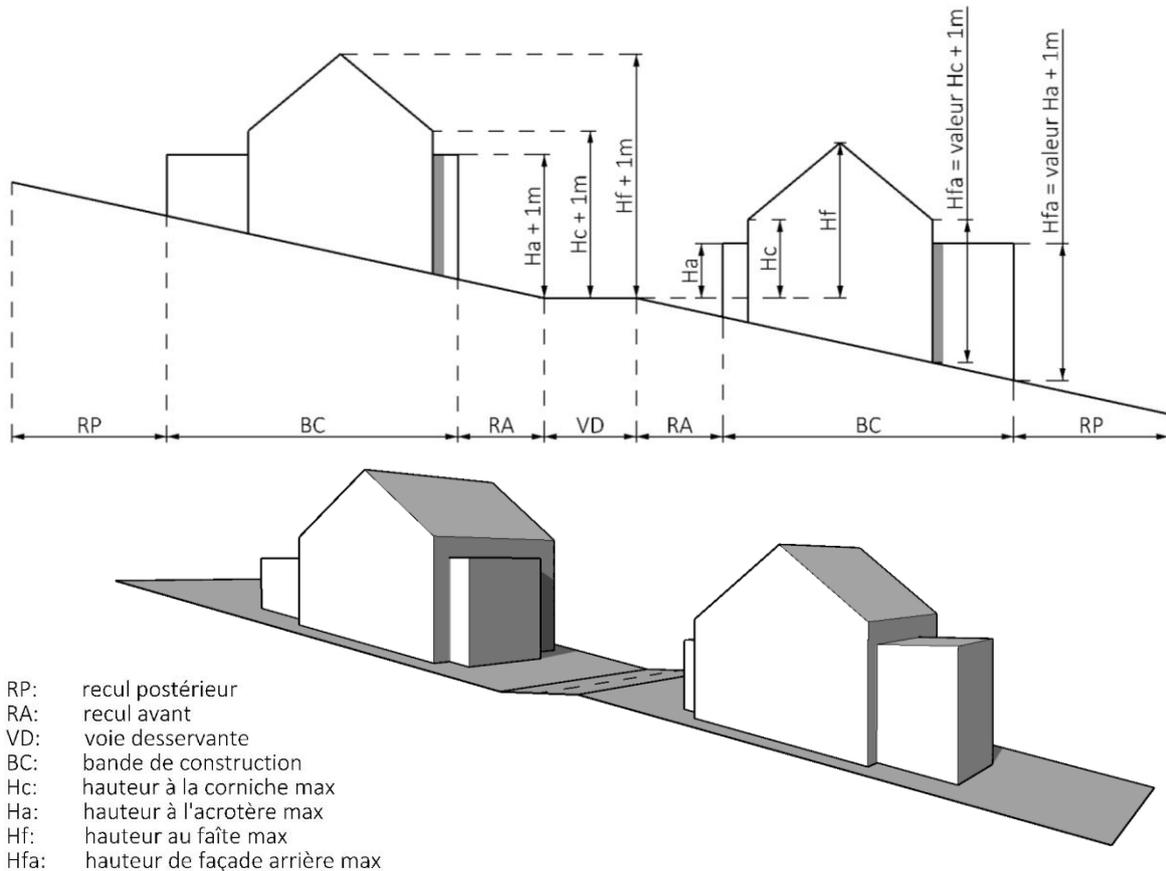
Hauteur des immeubles sur « terrain à forte pente »
